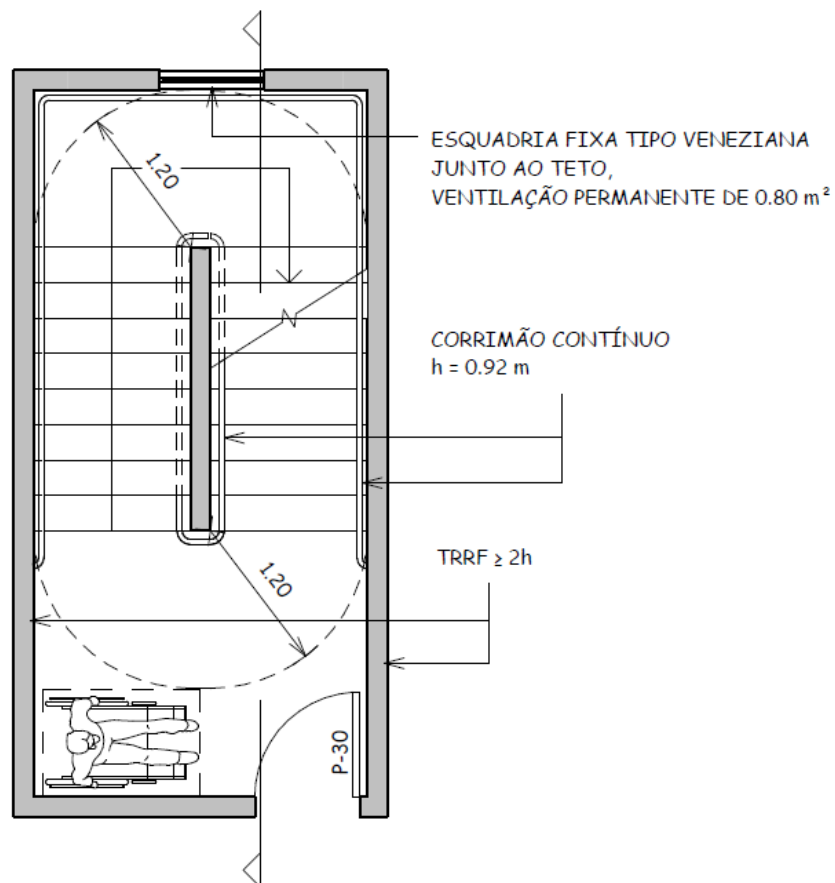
B - Escada protegida - pavimento intermediário (planta baixa).
